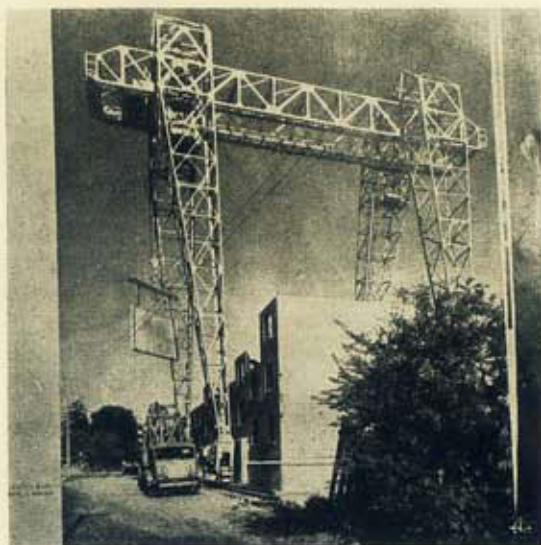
Elevação de um elemento vertical para colocação em obra.
